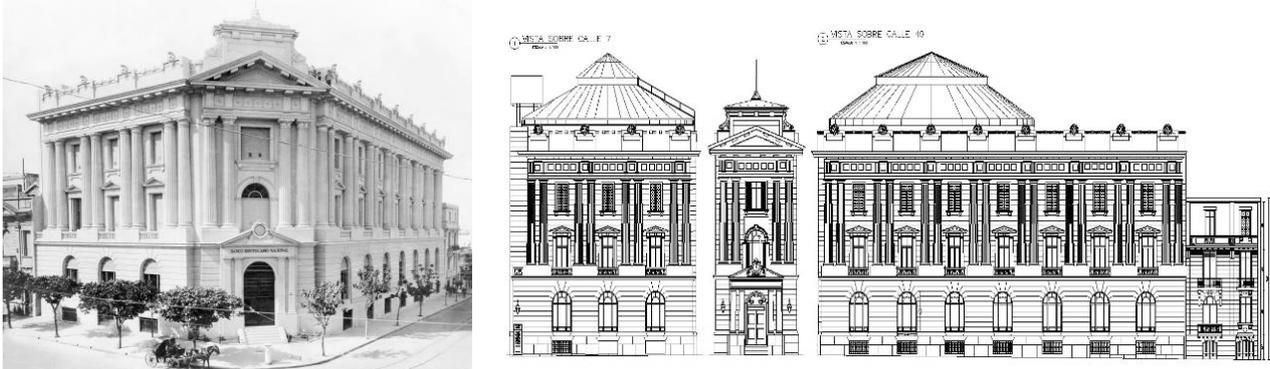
BH La Plata Pre inauguracion (1926) y fachada desplegada (Relevo 2010)
